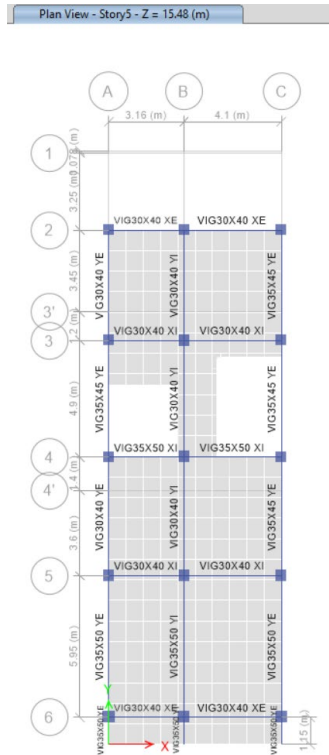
Distribución final de elementos estructurales en la PLANTA 5
